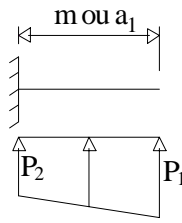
Comprimento da viga em balanço utilizada na “analogia de viga em balanço”.
